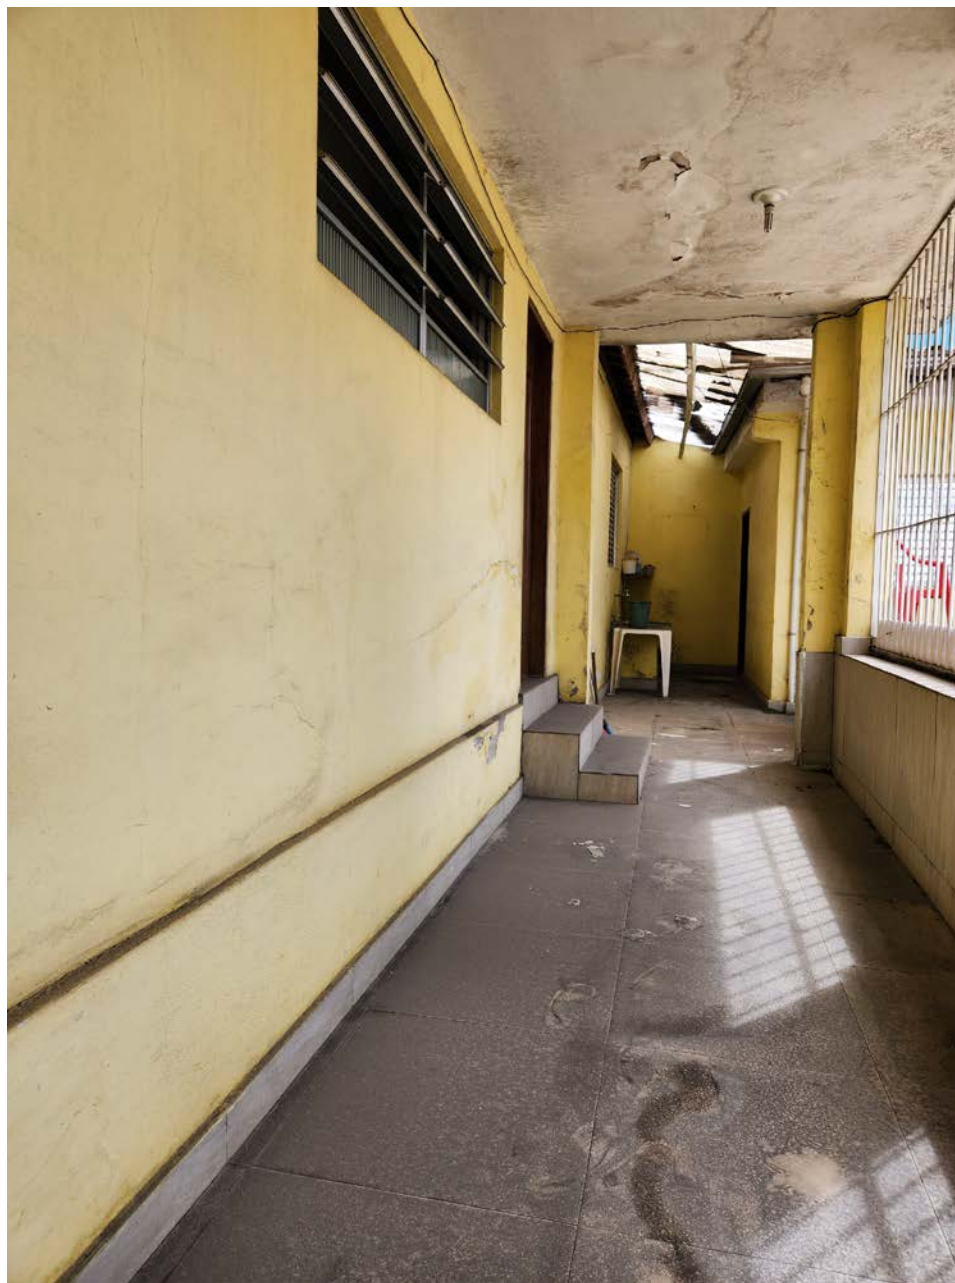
CORREDOR DE ACESSO AOS APARTAMENTOS.
